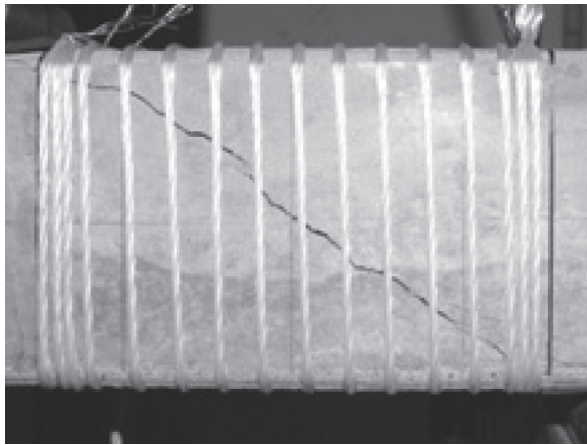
斜めひび割れ状況 (No.4)
